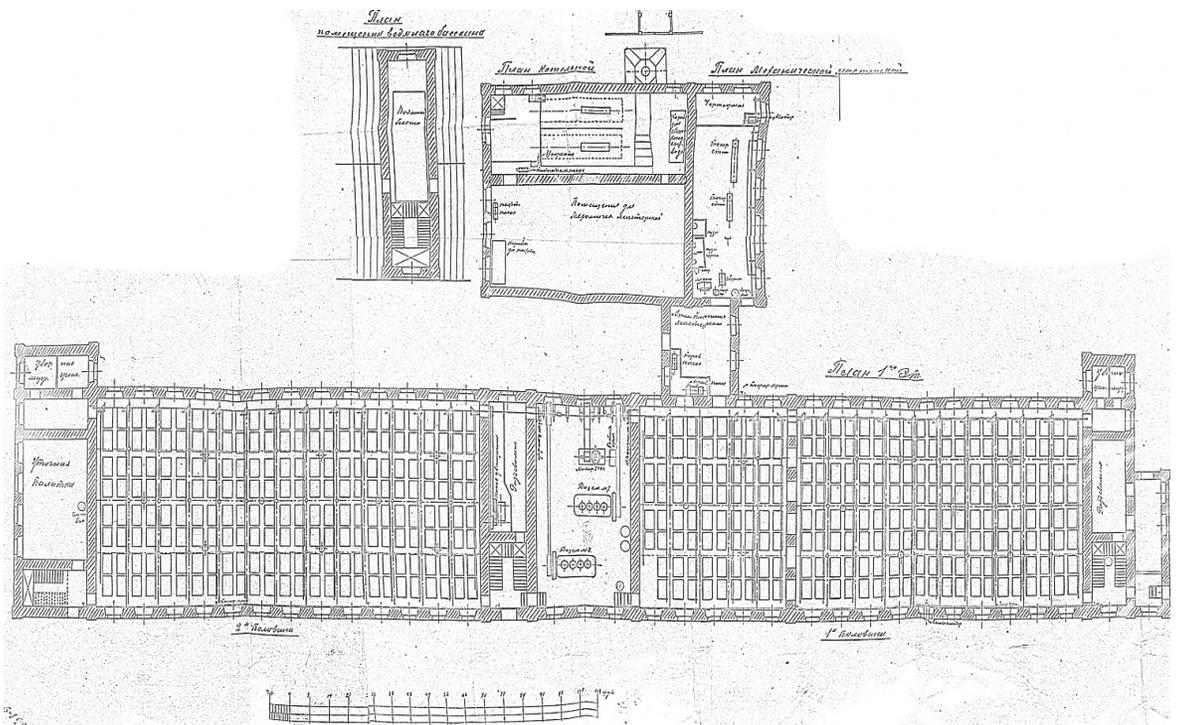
Ткацкий корпус. Чертеж обследования 1920-х гг. ГАИО
